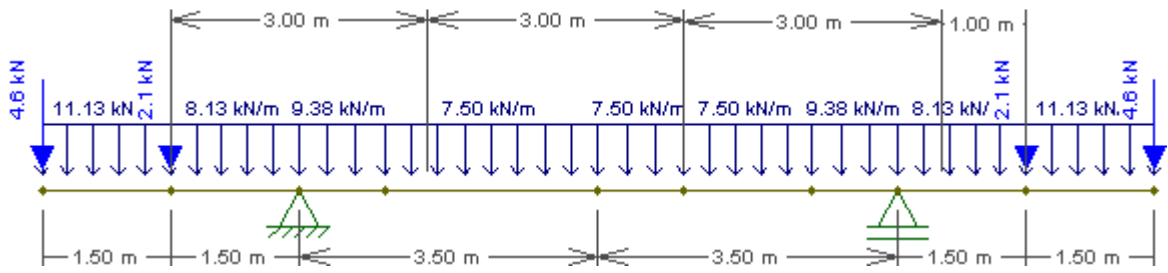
1– Aplicação das cargas permanentes na secção transversal
